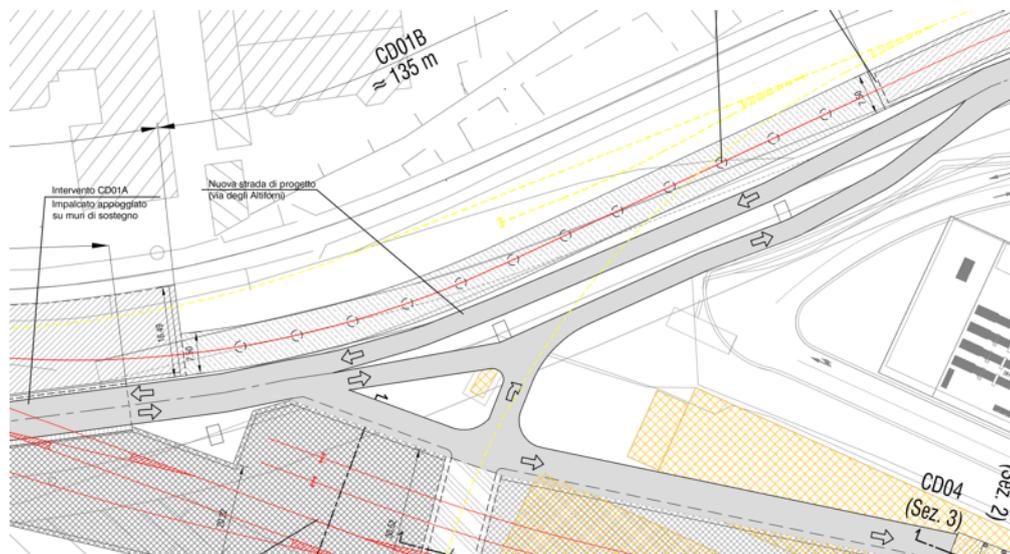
planimetria di dettaglio della zona interessata dal tratto CD01B (impalcato ferroviario)
